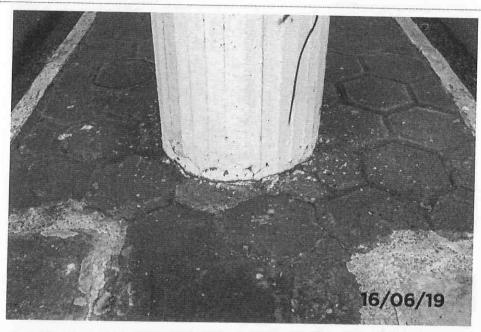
Detalhe de fissura e vegetação no pé do pilar.
